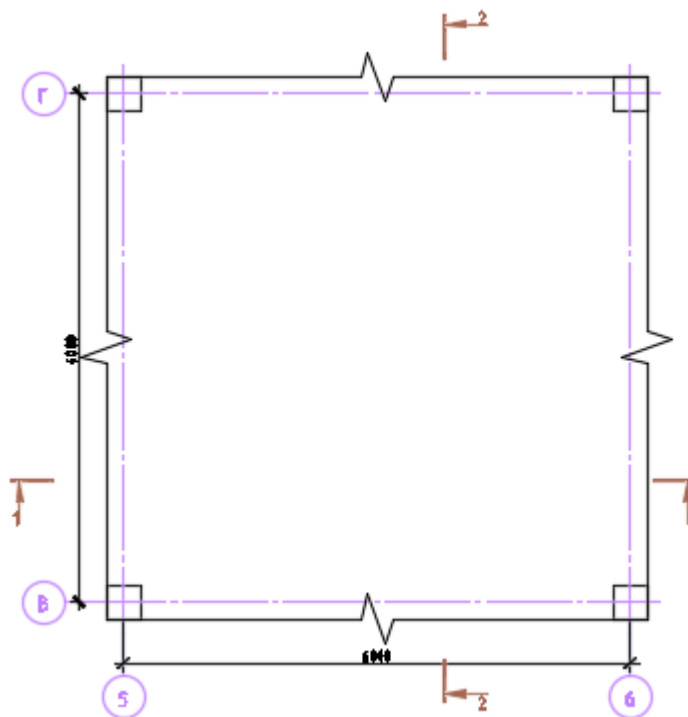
Схема рассчитываемого перекрытия на отметке + 4.200
